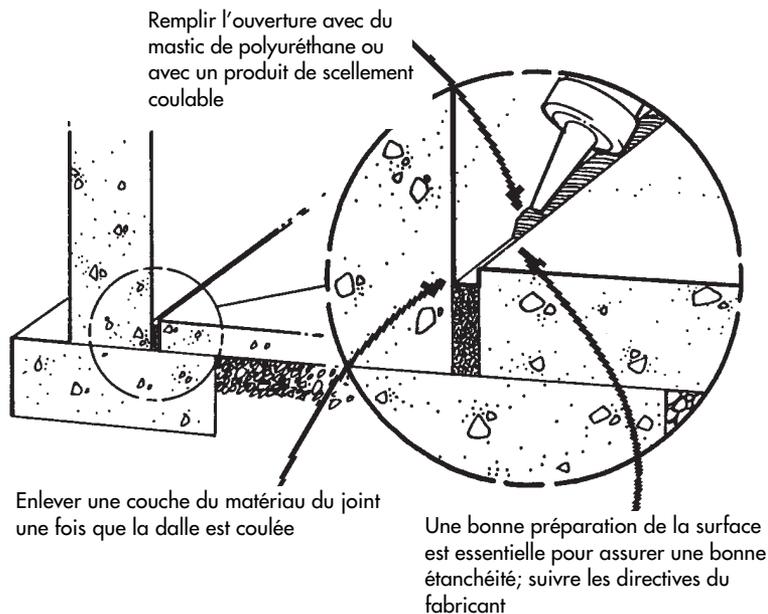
Obturer la jonction entre le mur de fondation et le plancher du sous-sol dans les constructions neuves
